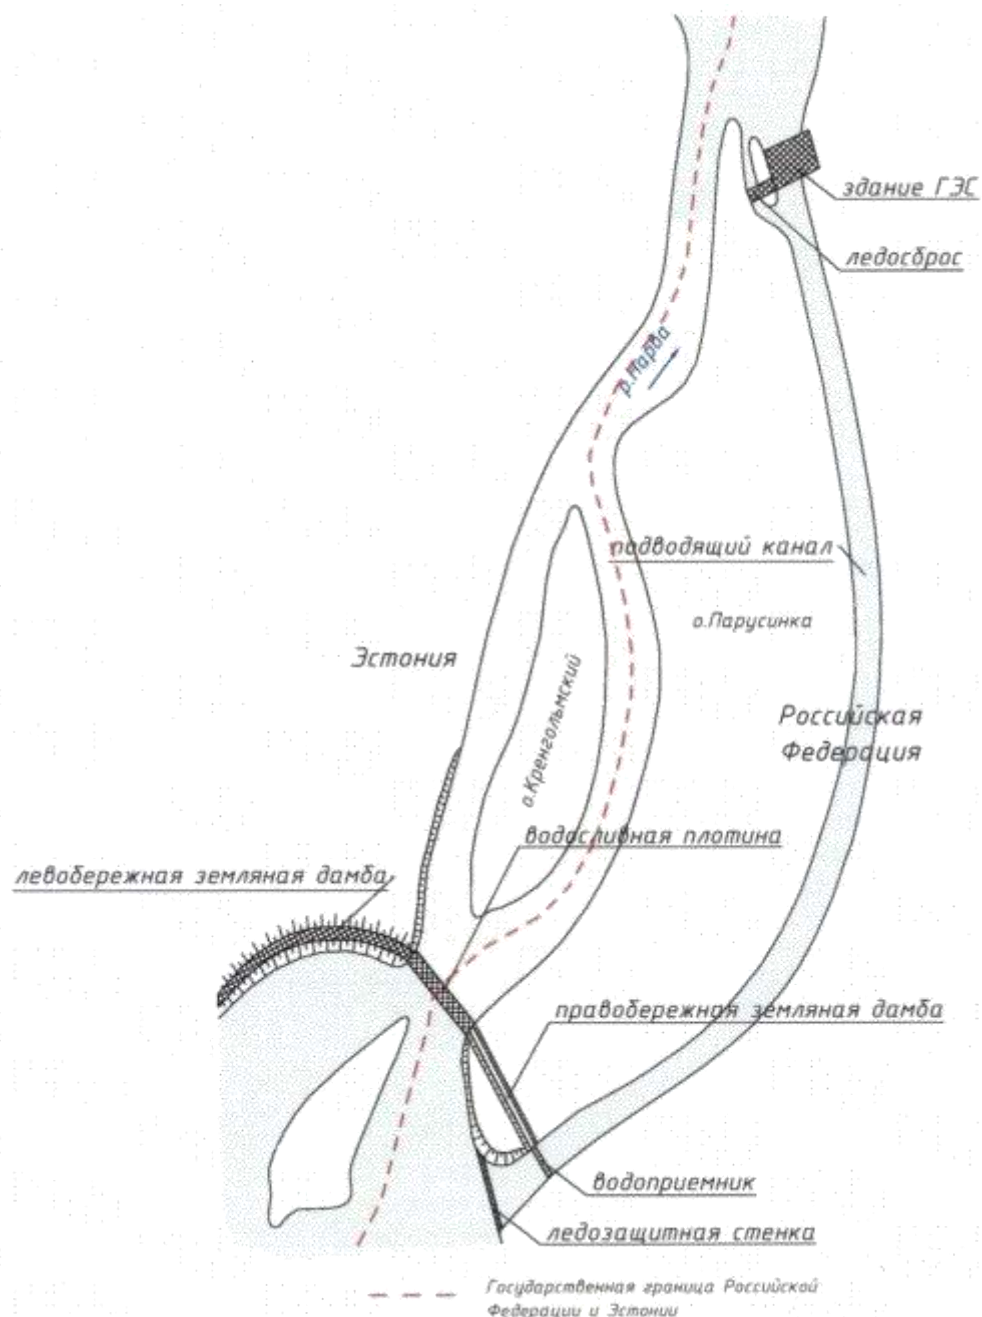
Схема расположения гидротехнических сооружений гидроузла Нарвского водохранилища [23]
